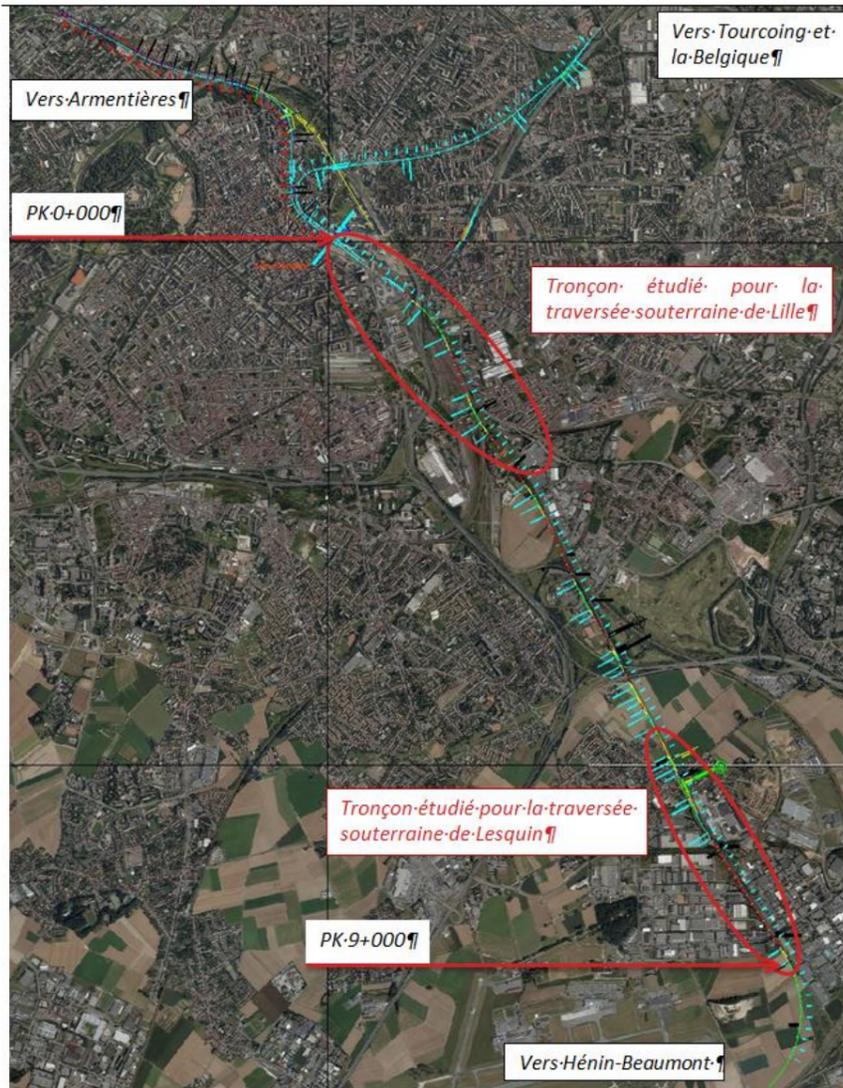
Implantation du tracé de référence au droit des traversées de Lille et de Lesquin en souterrain
